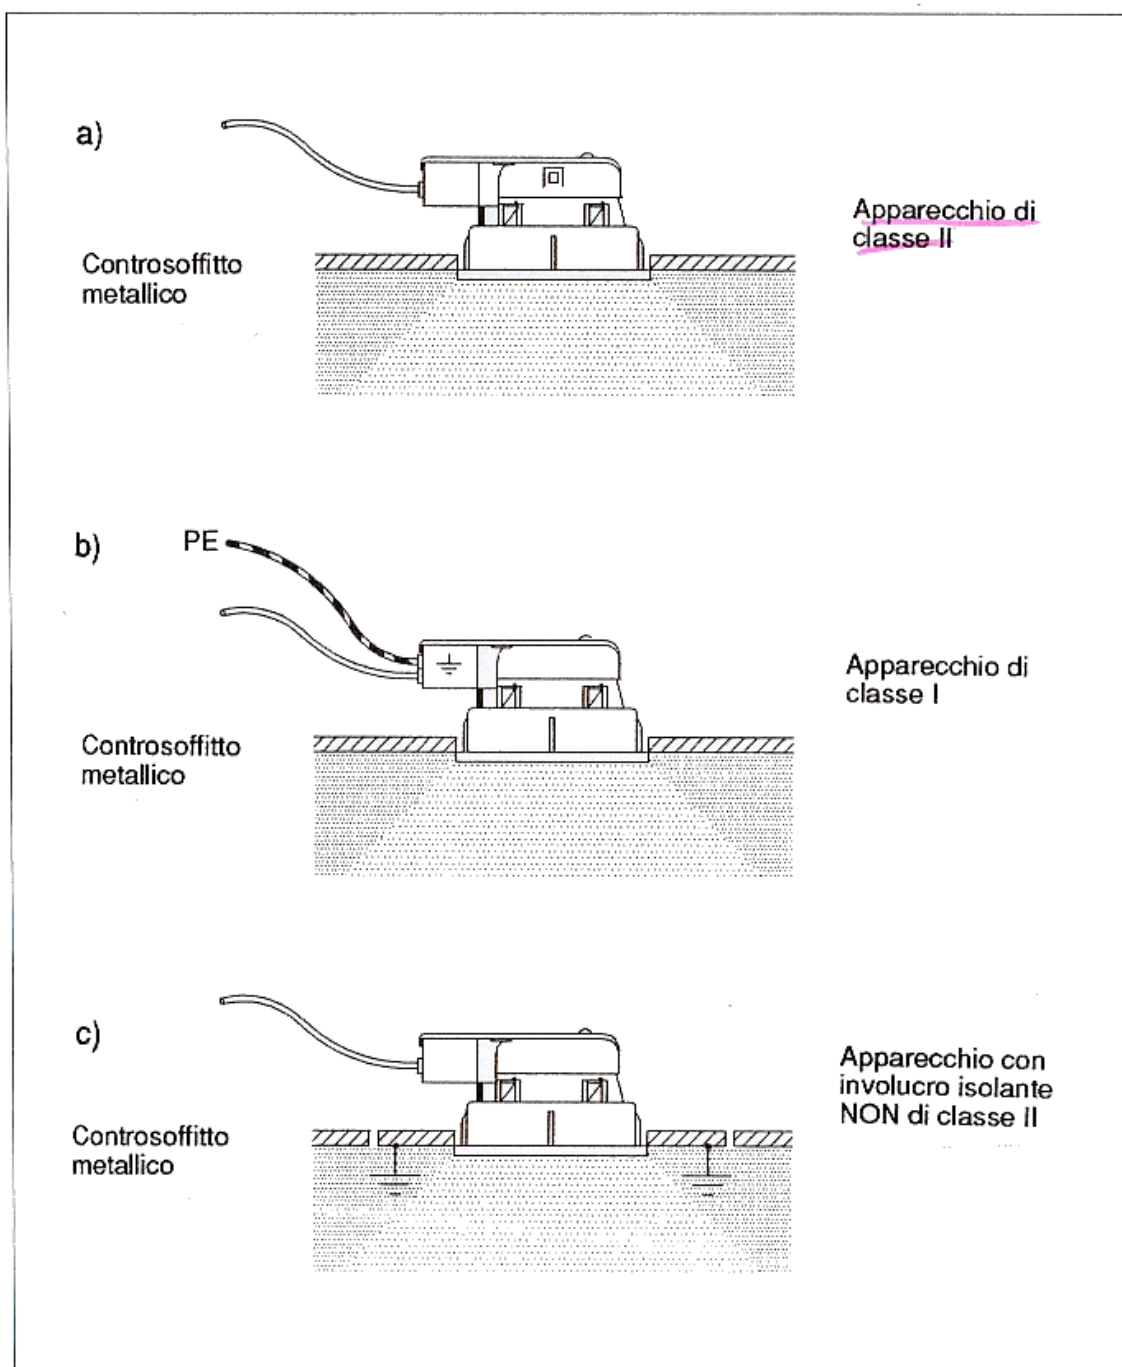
Messa a terra del controsoffitto metallico.
